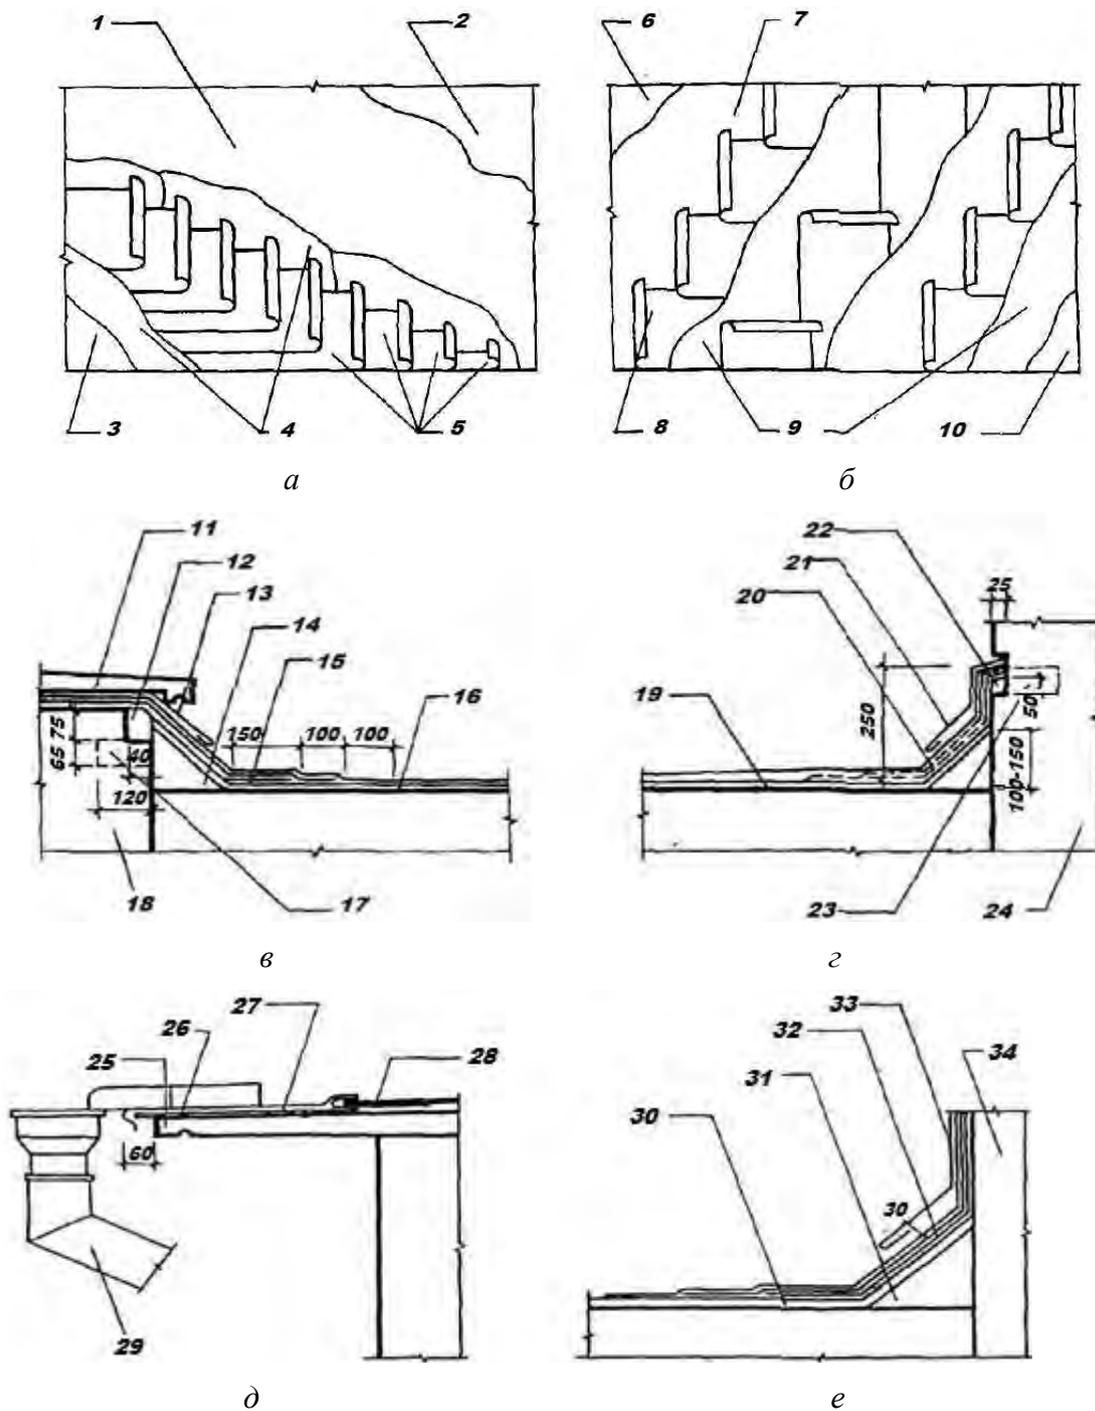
Рулонные кровельные покрытия: *а* — рубероидная кровля; *б* — мастичная кровля; *в* — деталь примыкания рубероидной кровли к парапету; *г* — деталь примыкания мастичной кровли к парапету (стене); *д* — деталь наружного организованного водостока при рубероидной крыше; *е* — узел примыкания кровли к вертикальному ограждению: 1, 7 — грунтотка; 2, 6 — основание; 3, 10 — защитный слой; 4, 9 — мастика; 5 — четыре слоя рубероида; 8 — стеклохолст; 11 — парапетная плита; 12 — деревянная рейка; 13, 21 — оцинкованная сталь; 14 — цементный раствор; 15, 32 — три дополнительных слоя рубероида; 16, 19, 28, 30 — кровля; 17, 24, 34 — стена; 18, 23 — деревянная пробка; 20 — три дополнительных слоя мастики; 22 — деревянная рейка; 25 — карнизная плита; 26 — Т-образный костыль; 27, 33 — оцинкованная кровельная сталь; 29 — водосточная труба; 31 — цементный раствор
